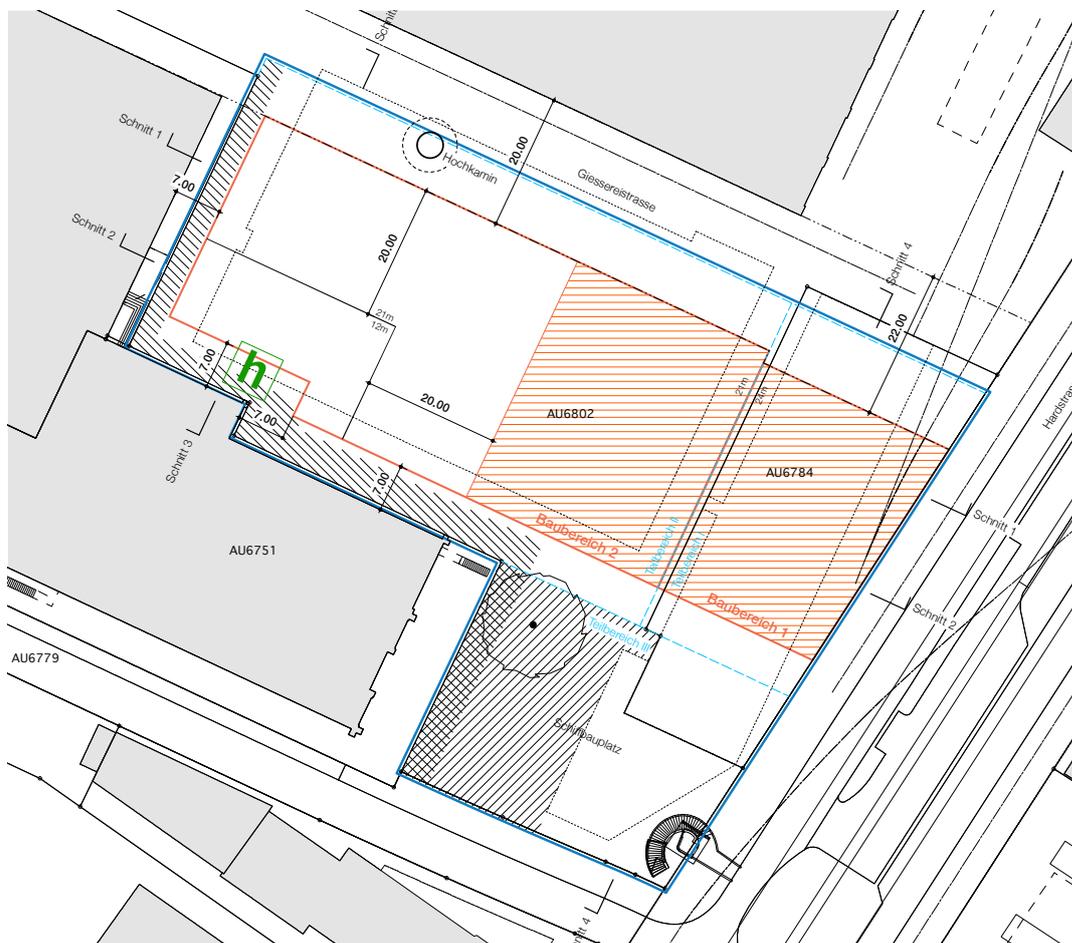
Ausschnitt Gestaltungsplan Schirmhaus
